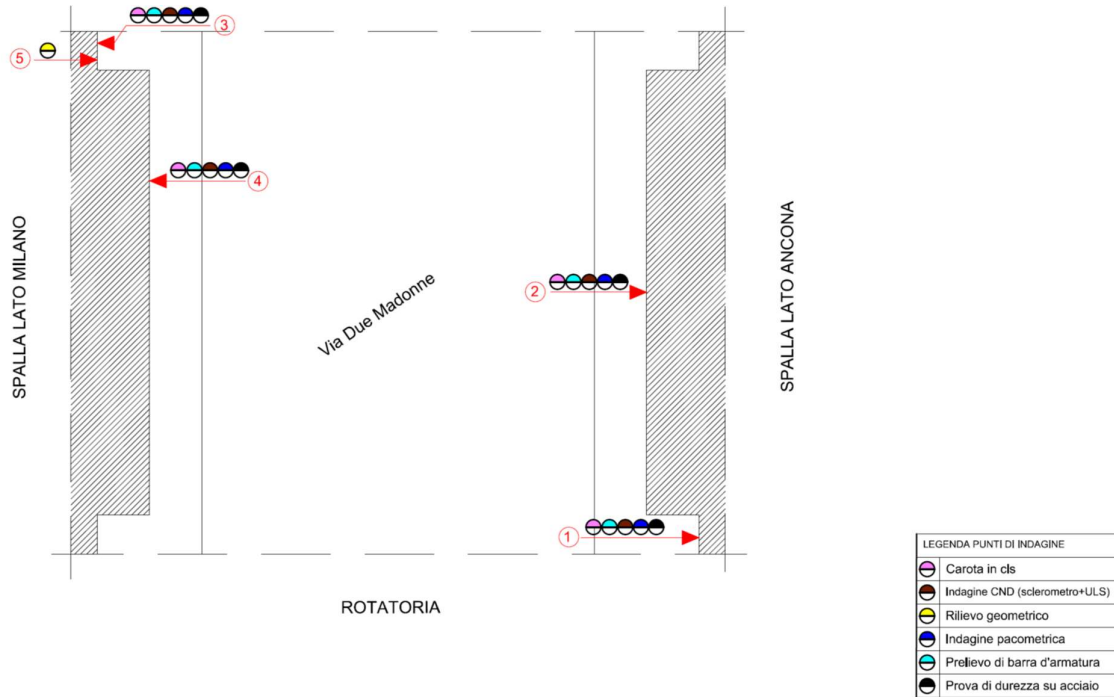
Stralcio planimetrico delle indagini eseguite sulle strutture esistenti
